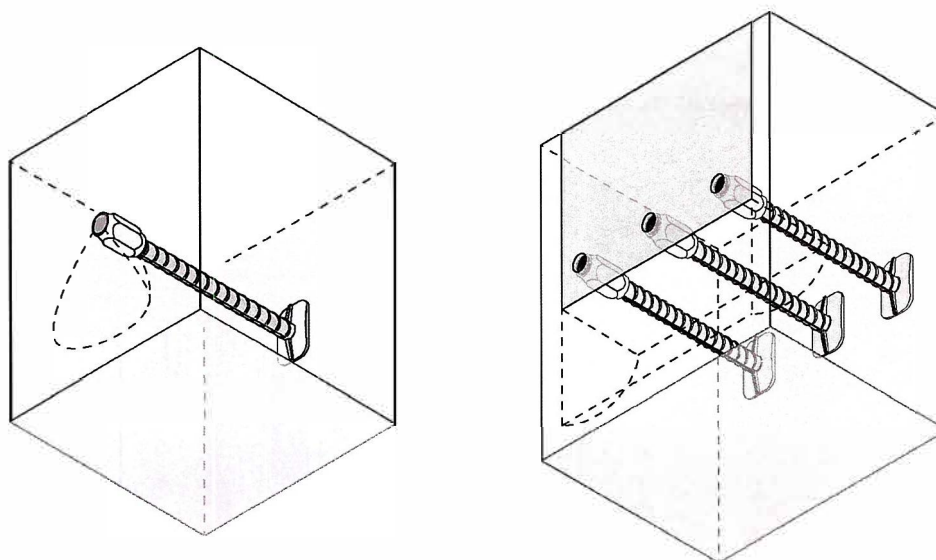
Połączenia stalowych elementów konstrukcyjnych z elementami żelbetowymi, wykonane z zastosowaniem trzpieni HSC-B
